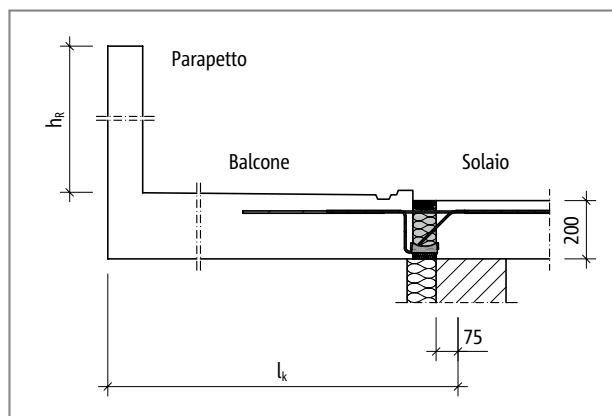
Schöck Isokorb® T tipo KL: schema statico
